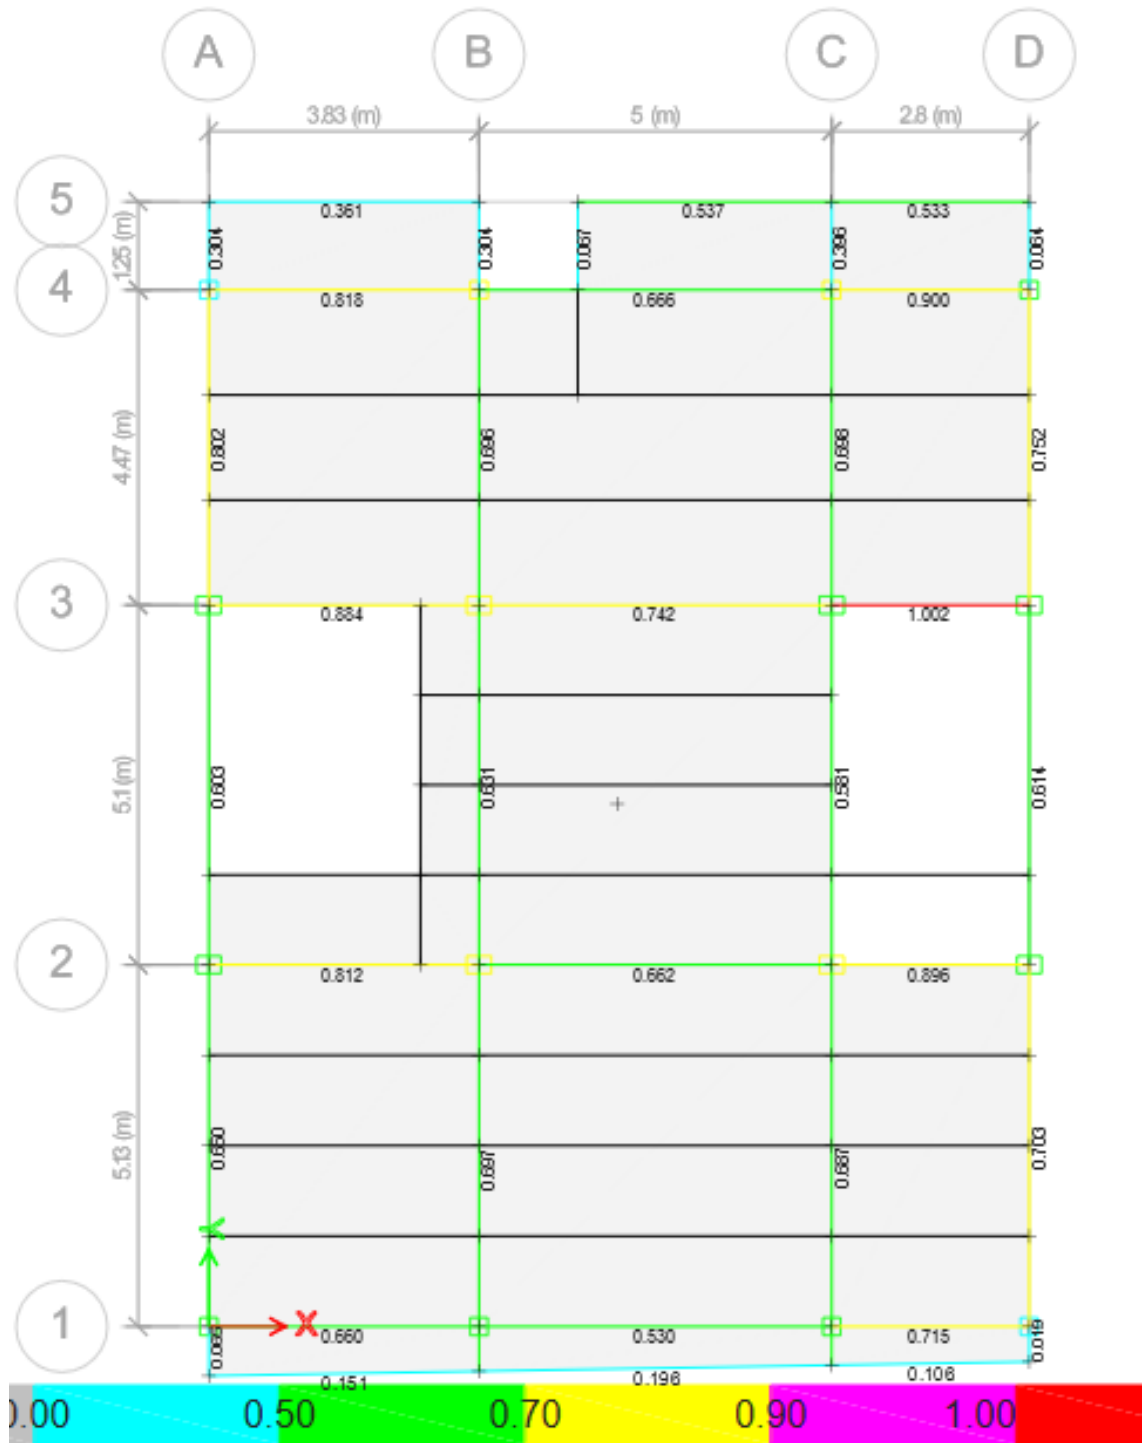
Vista en planta Nv.+6,30 de secciones principales, con diseño AISC 360-16 demanda/capacidad
